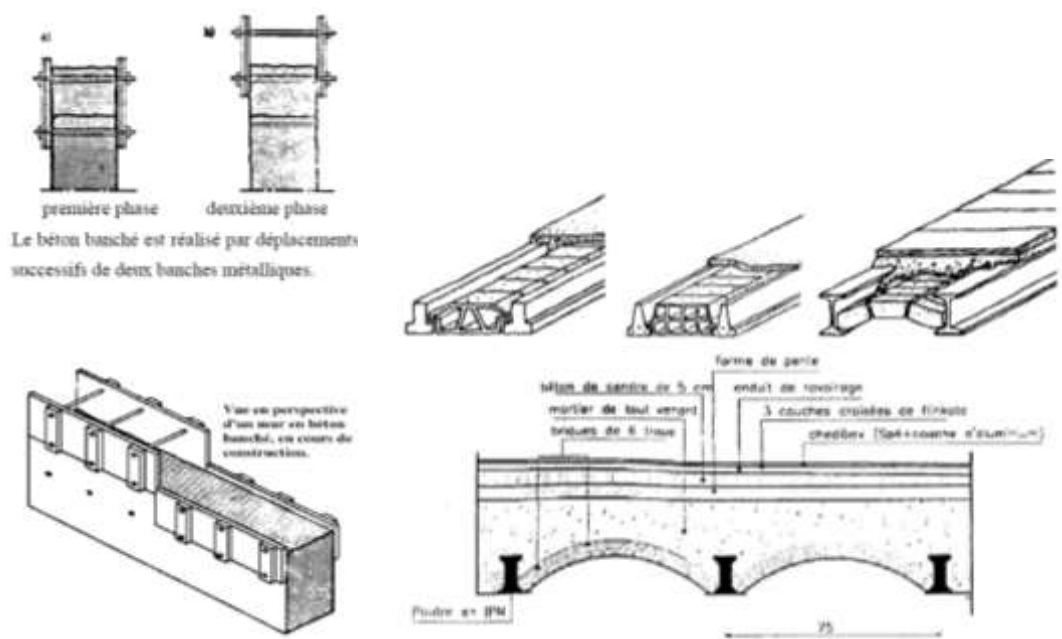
construction des murs en béton banché (à gauche) ; construction de plancher en utilisant les poutres en IPN (à droite)
